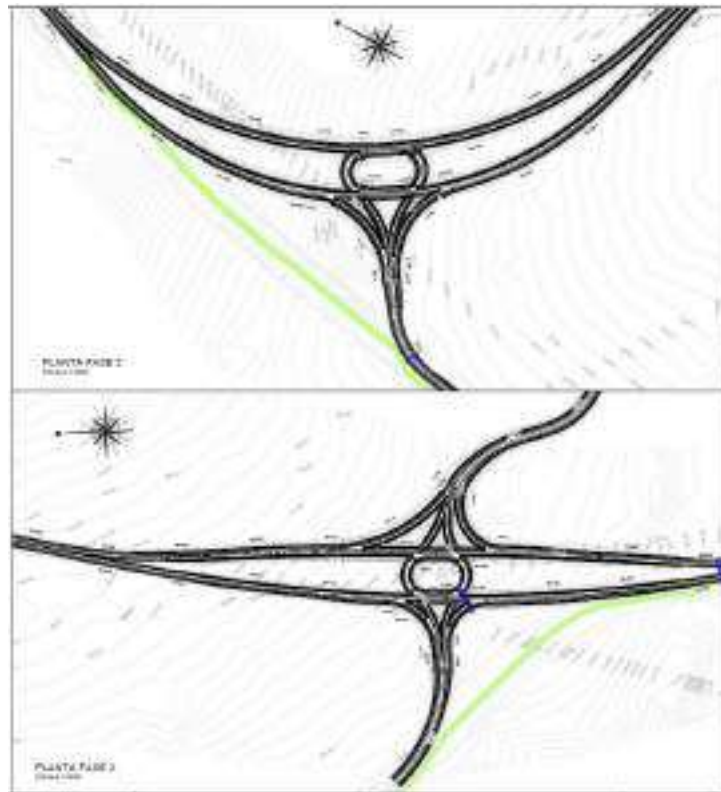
Croquis tipo para zonas de obra y zona de tránsito en fase 2 de Desvíos Tipo IV.
